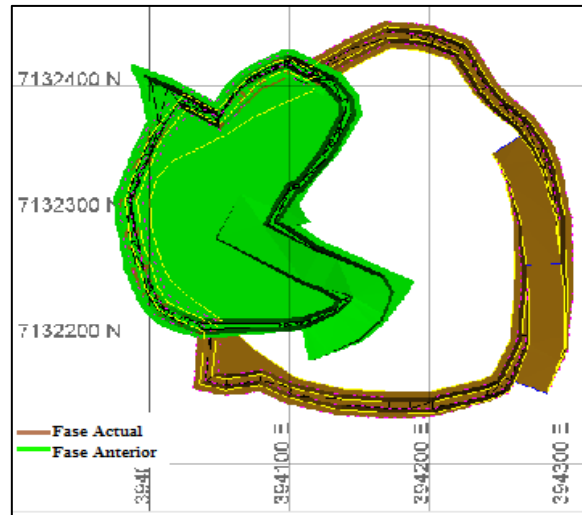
LGIY Fase 3 – Corte en sección - Planta banco L1130
